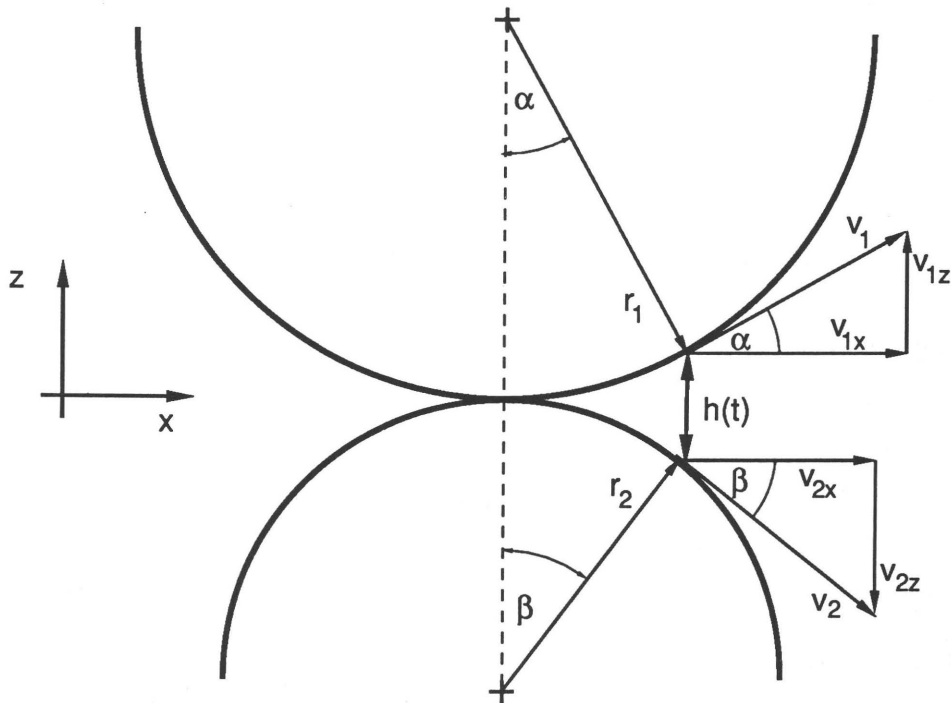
senkrechter Abstand zweier Berührungspunkte nach Durchlauf durch Walzenspalt
